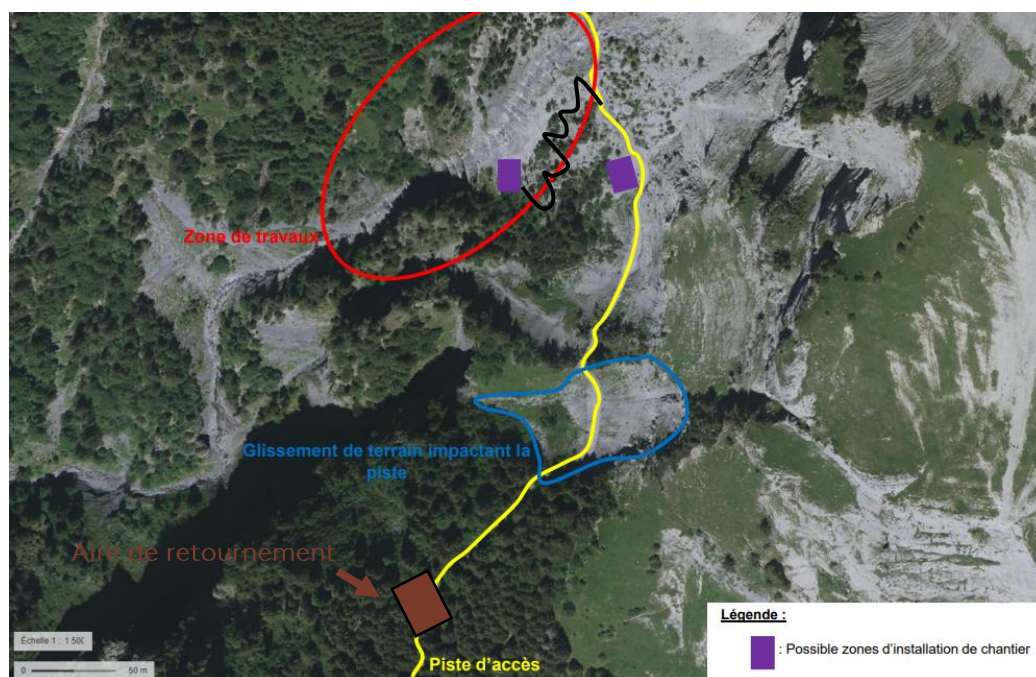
Plan de situation des possibles zones de stockages ou d'installation de chantier, du sentier pédestre d'accès au barrage 10 (noir) et impact du glissement de terrain sur la piste de la Zeta.
